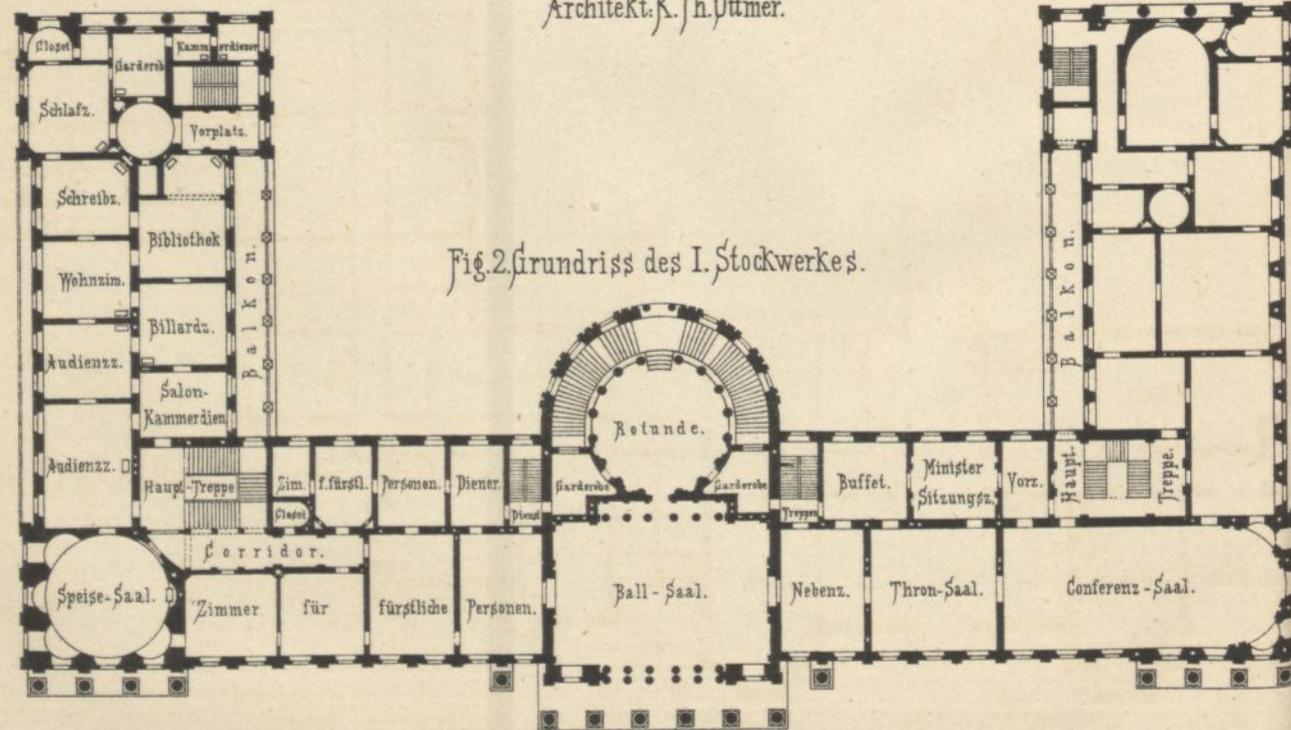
Grundriss des I. Stockwerkes.
